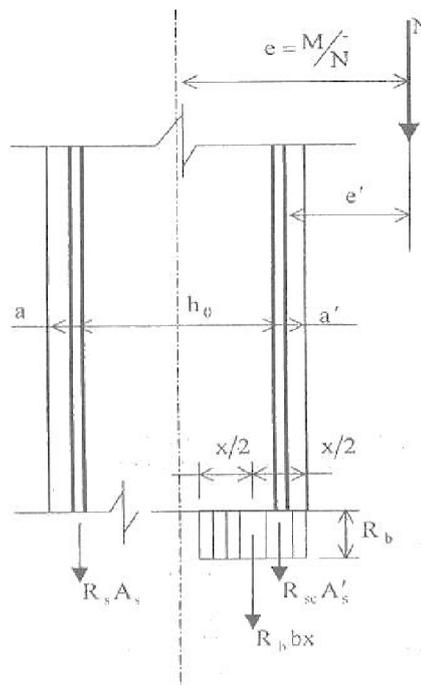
Расчетная схема внецентренного сжатого элемента.
